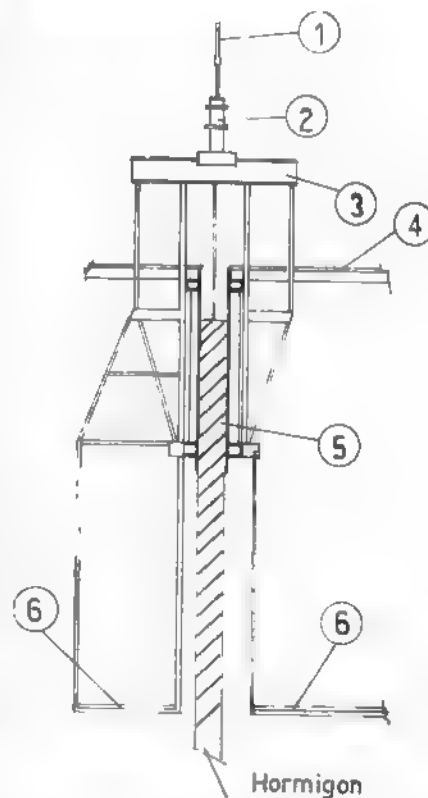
Esquema encofrado deslizante, 1, barras metálicas de trepado. 2, dispositivo de elevación. 3, caballete. 4, plataforma superior de trabajo. 5, panel de encofrado. 6, plataforma inferior de trabajo.
